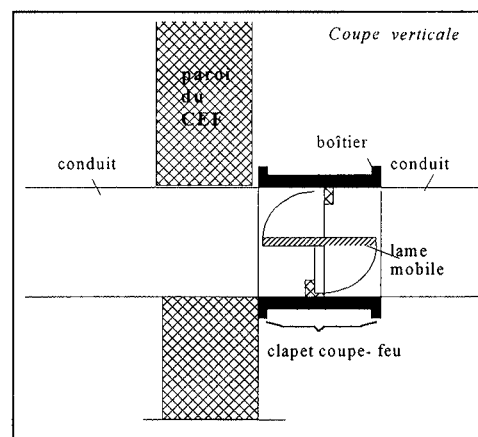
Mise en place de clapet coupe-feu dans les conduits traversant une paroi de CEF.
